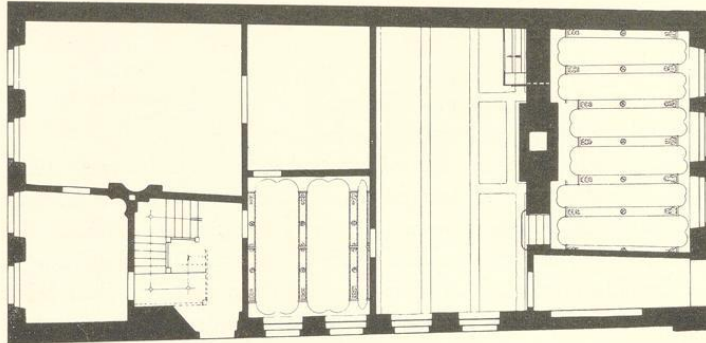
Grundriß des Erdgeschosses des Hauses Kuhstraße 3
